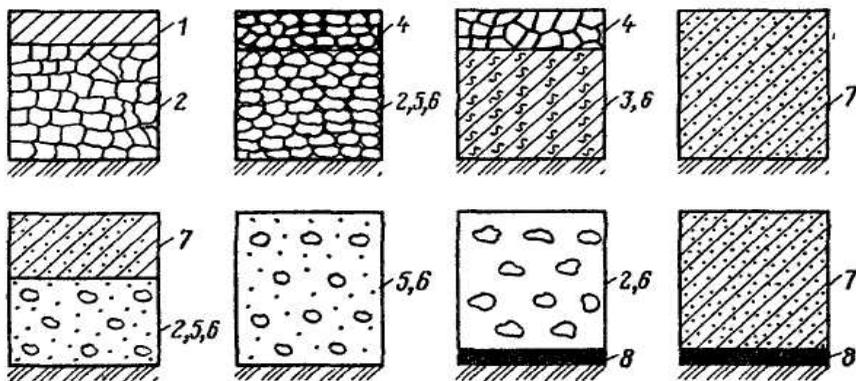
Типовые конструкции укрепления обочин:
